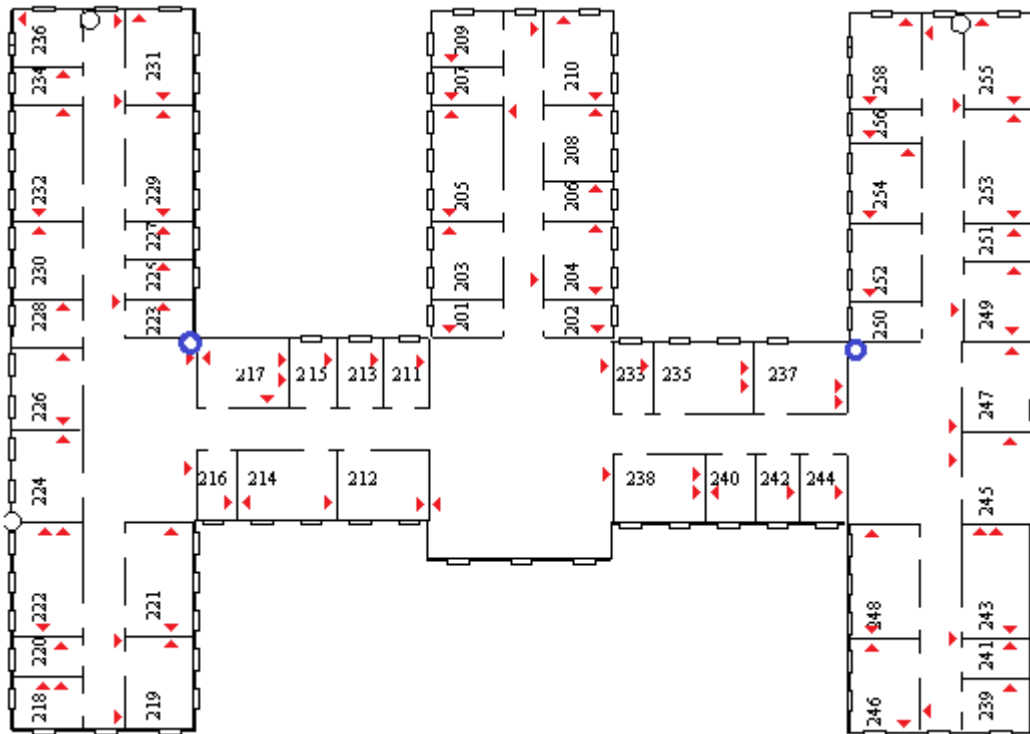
План розміщення інформаційних розеток у будівлі №2
